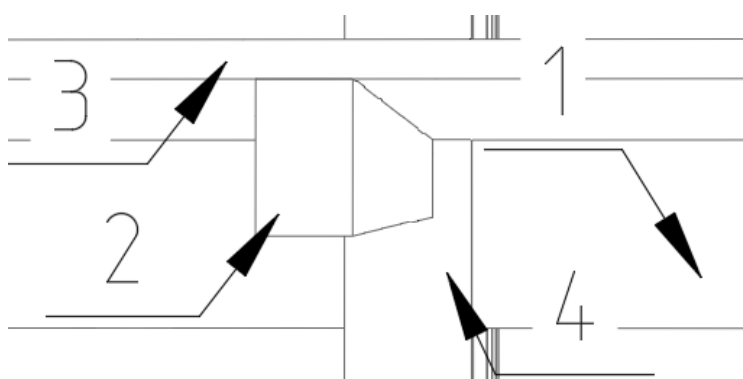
Фрагмент конструктивной модели первого варианта (1 - главная балка, 2 - второстепенная балка, 3 – плита перекрытия, 4 - колонна)
